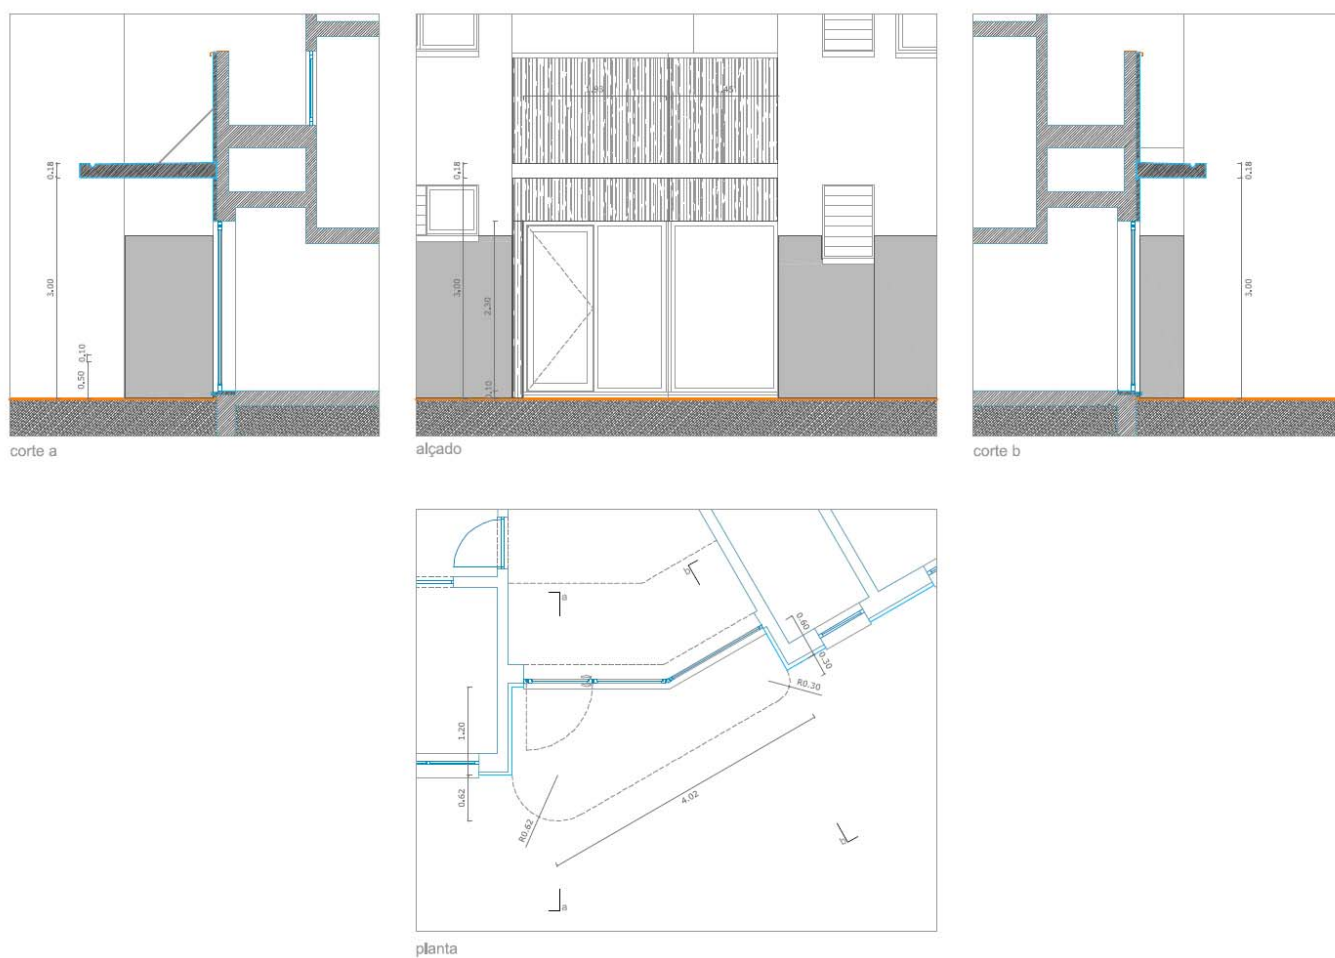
Proposta de requalificação de entrada de tipologia de “ângulo”. Alçado, corte e planta (escala 1/50).
